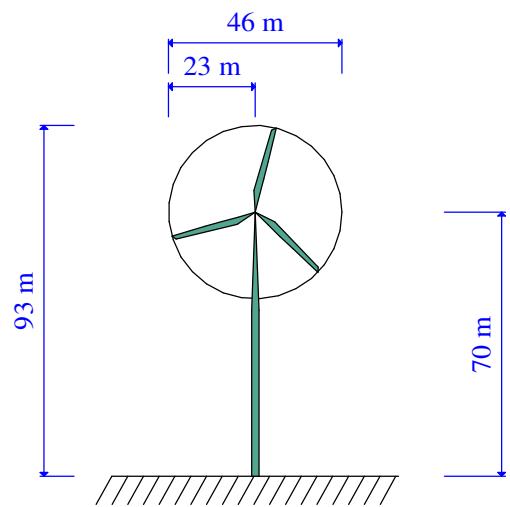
Abmessungen des zugrunde gelegten Anlagentyps
